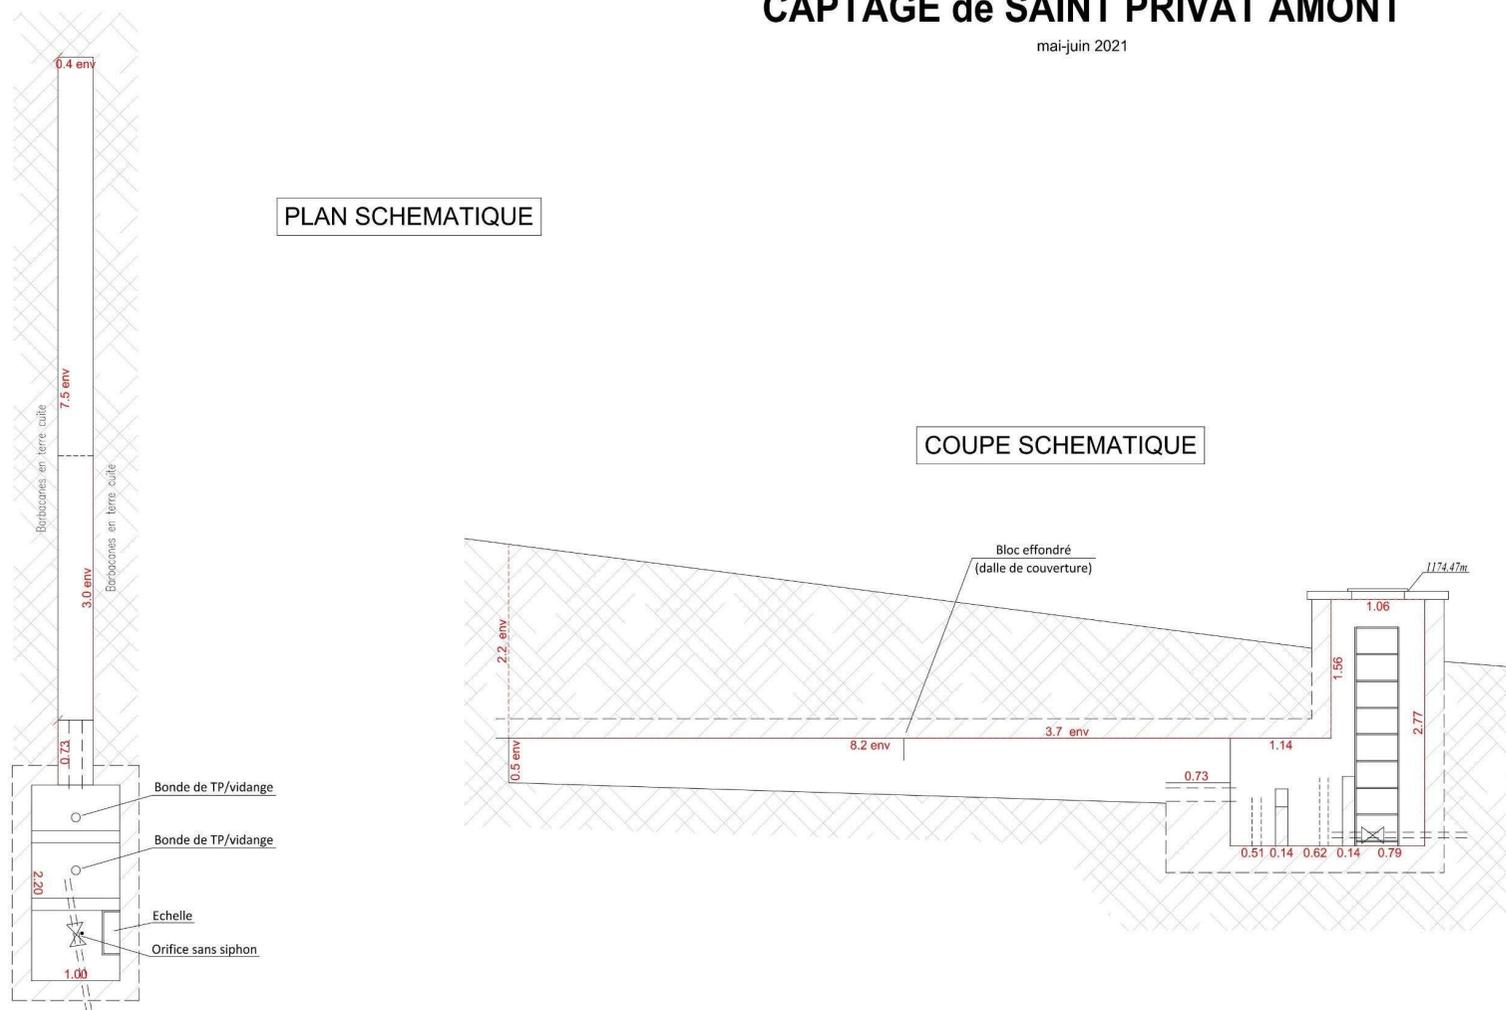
Plan schématique du captage de SAINT-PRIVAT AMONT
